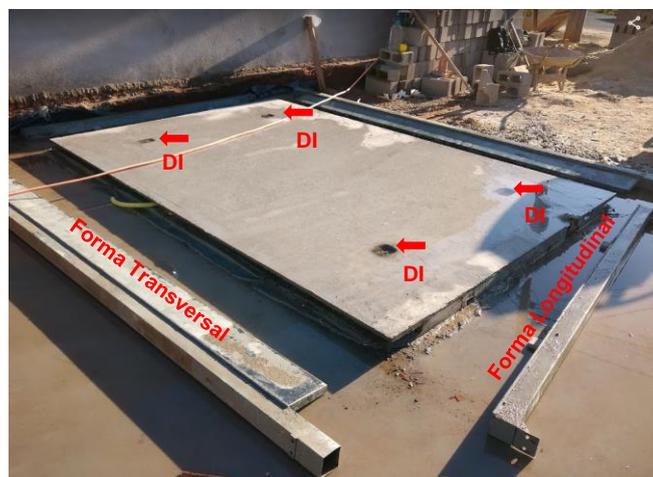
Primeiro painel de LMPM produzido: 1º pavimento
